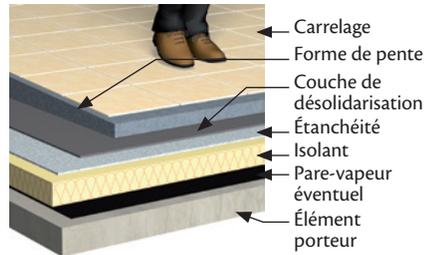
Destinations des toitures-terrasses et exemples de complexes d'étanchéité
